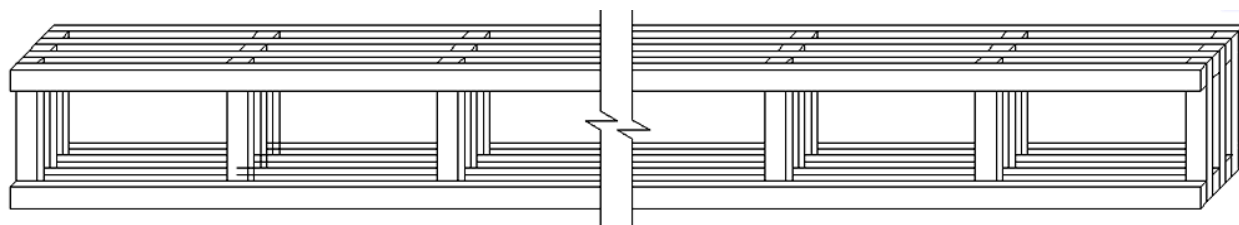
Деревянная безраскосная ферма покрытия из досок с клеевыми стыками
